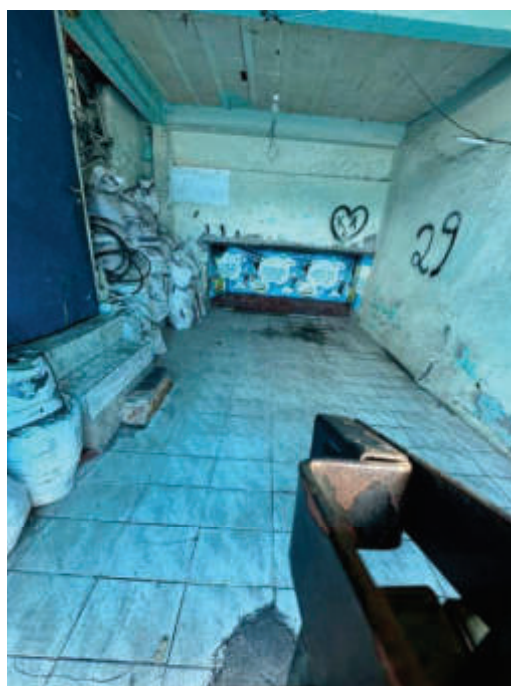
Rua Estados Unidos n.º 29 – GARAGEM
